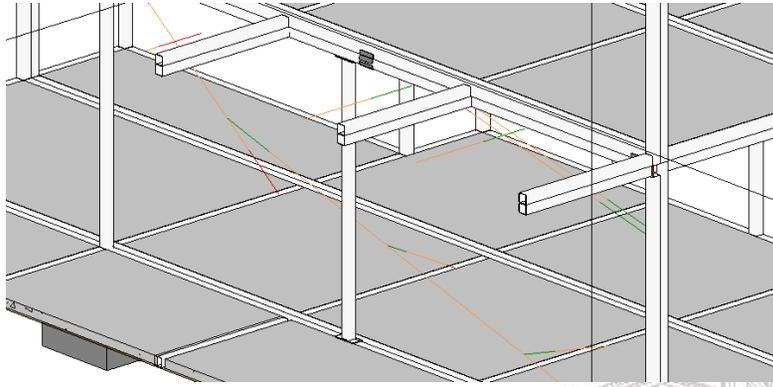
Colocación de pilar de tránsito, utilizado para la transportación previa del módulo.
